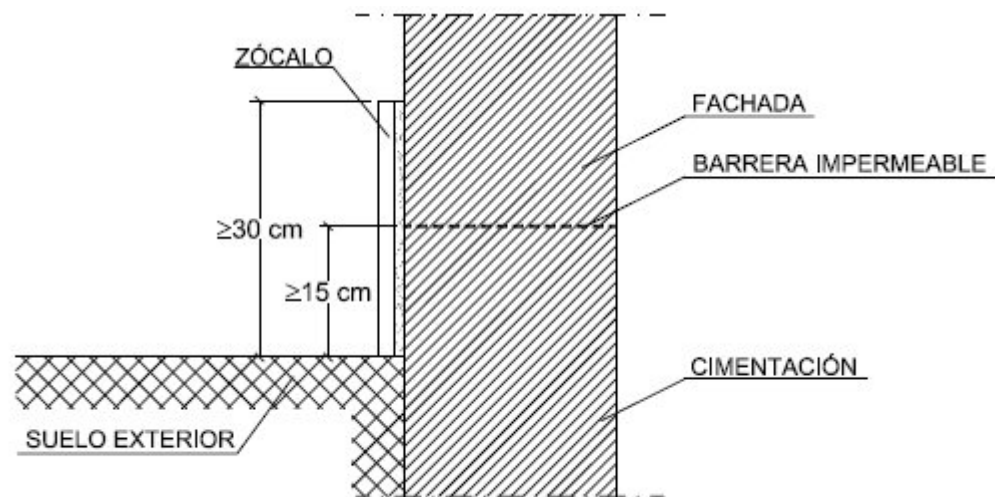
Ejemplo de arranque de la fachada desde la cimentación
